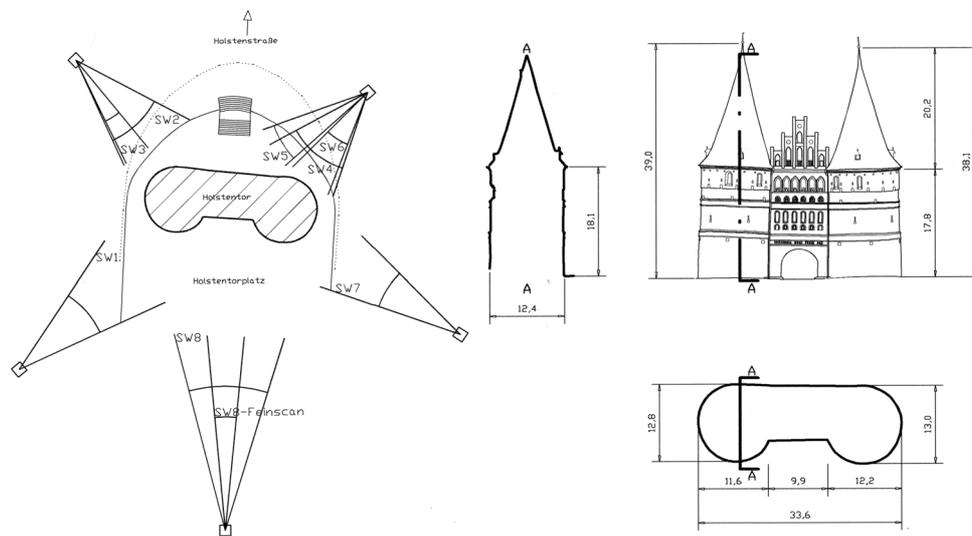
Laserscannerstandpunkte am Holstentor (links), 2D Auswertung mit Grundriss – Ansicht – Schnitt (rechts)
